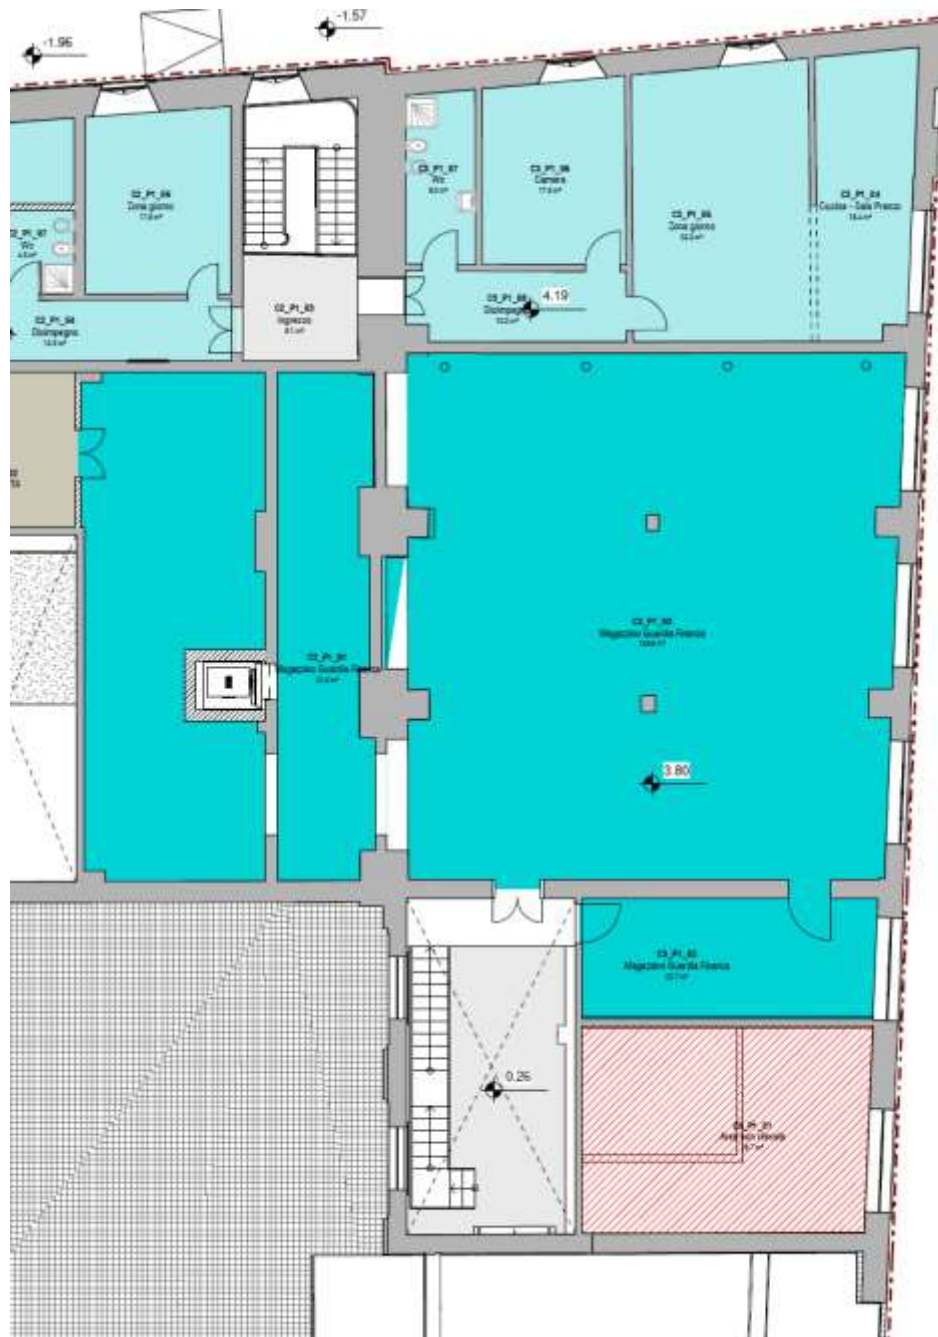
Edificio C3, pianta piano primo – estratto della pianta con le indicazioni funzionali
